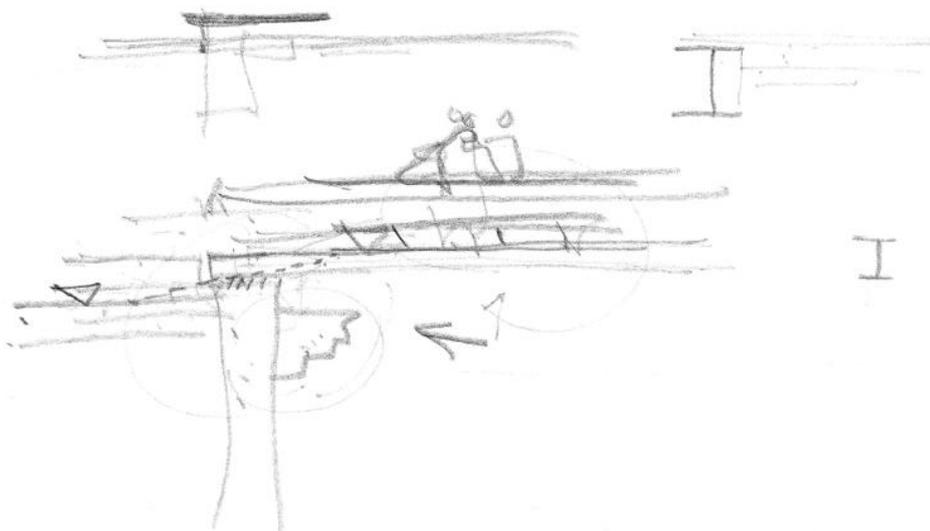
Interface entre passarela metálica e alvenaria existente (pátios laterais no 2º pav.).
